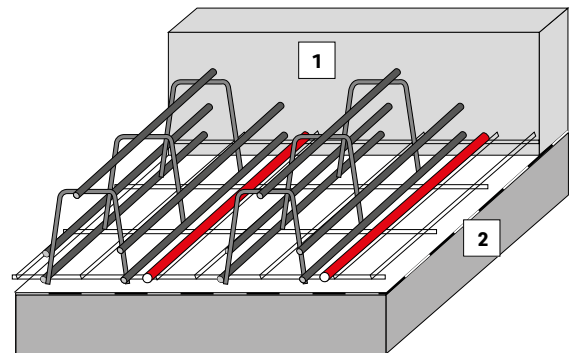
Mit Stahlmatten bewehrte Bodenplatte; Standardkonstruktion Heizungsrohre auf der unteren Bewehrungsmatte montiert
